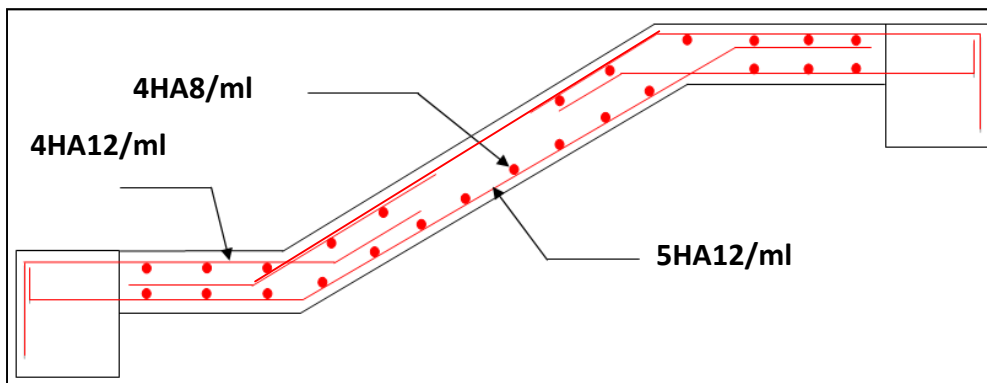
schéma de ferrailage de la partie AB de l'escalier étage courant
